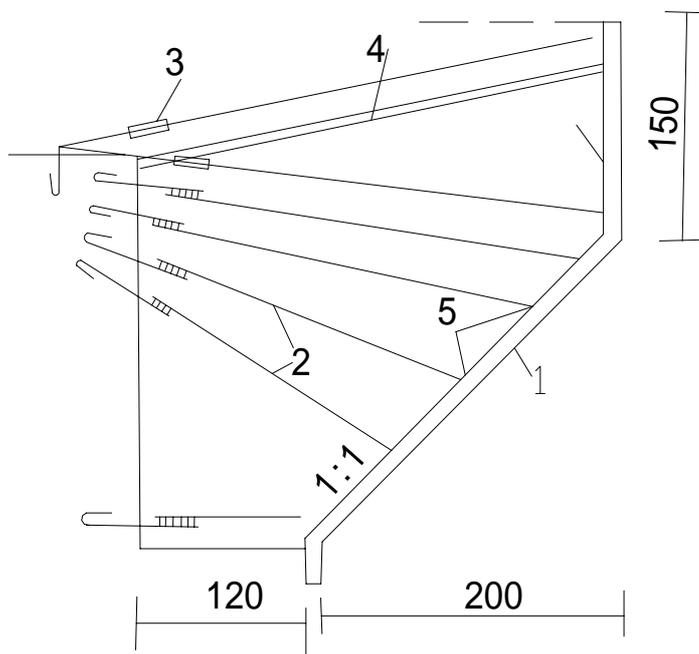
板式钢筋混凝土牛腿模板(单位 cm)
